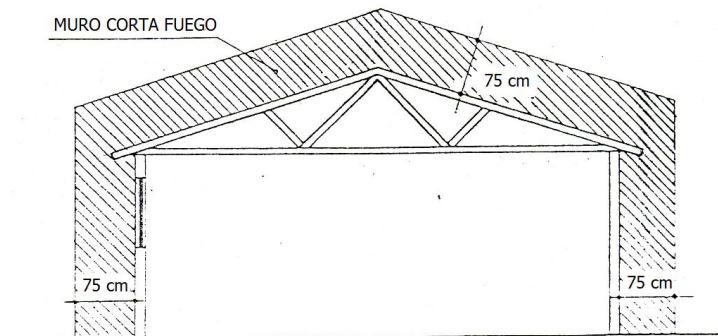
Dimensiones del muro corta fuego, vista frontal.
